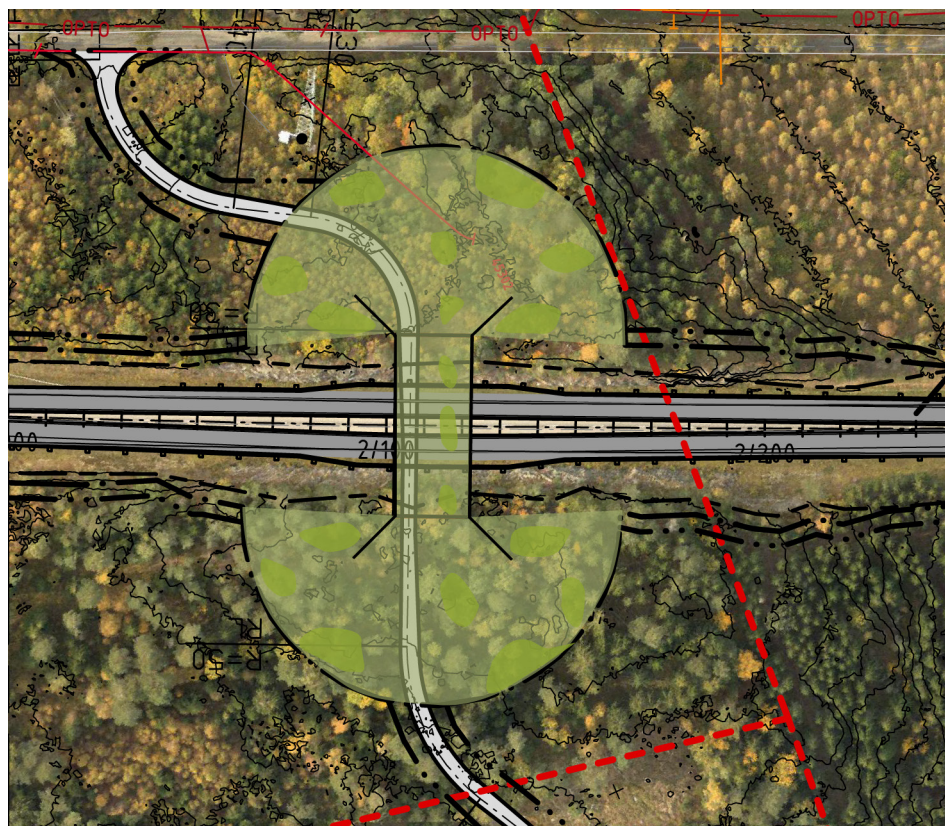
Exempel på utformning av en 20 m bred faunapassage i plan vid km 2/100.
